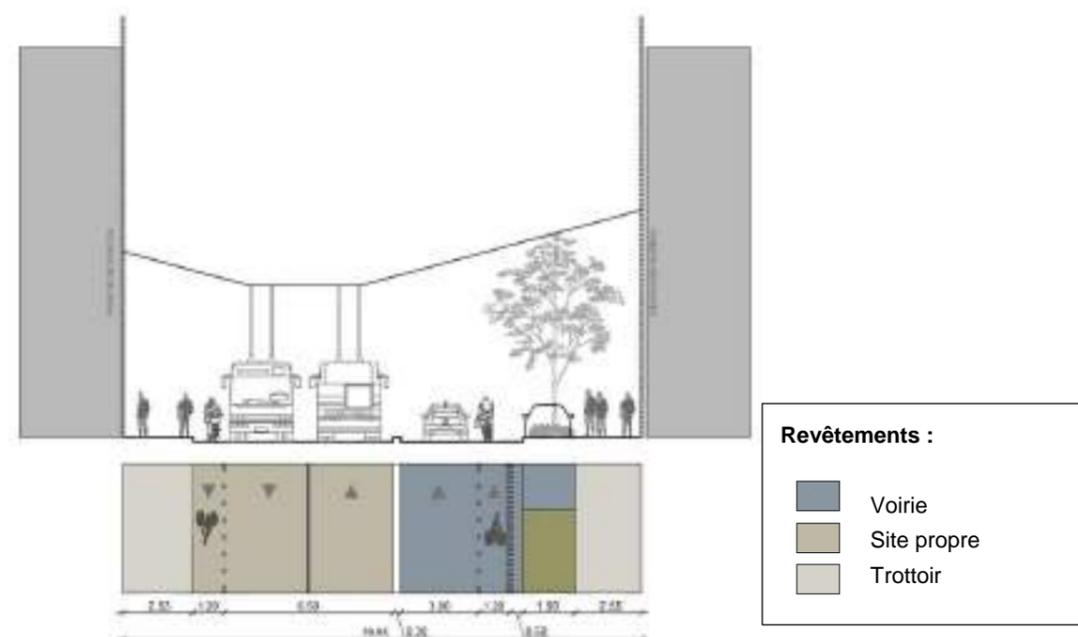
Exemple de coupe pour la séquence du Cours (Source : plan AVP2 modifié – EGIS – Octobre 2014)
